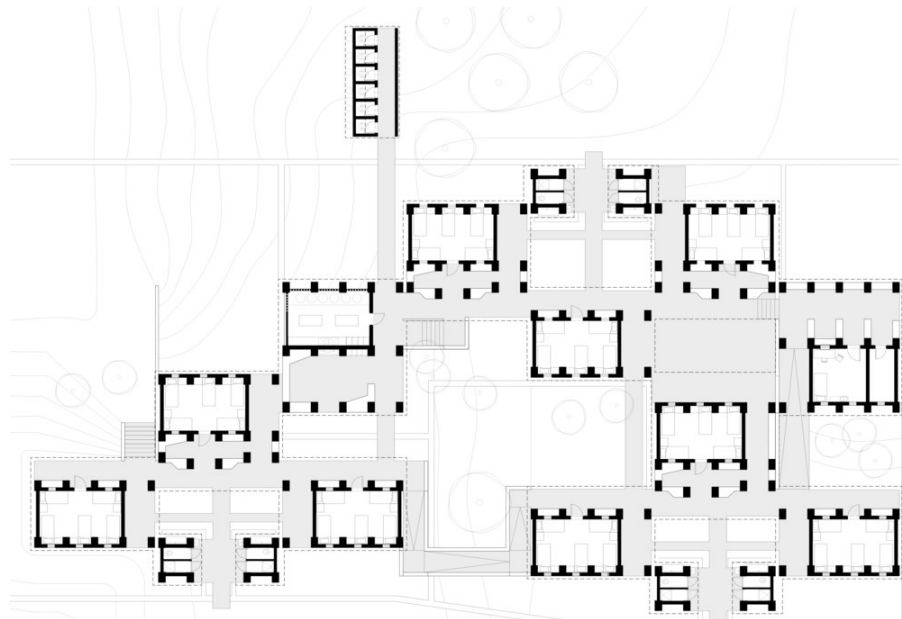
Centro para Gestantes. - Planta Baixa. Fonte: Archdaily
